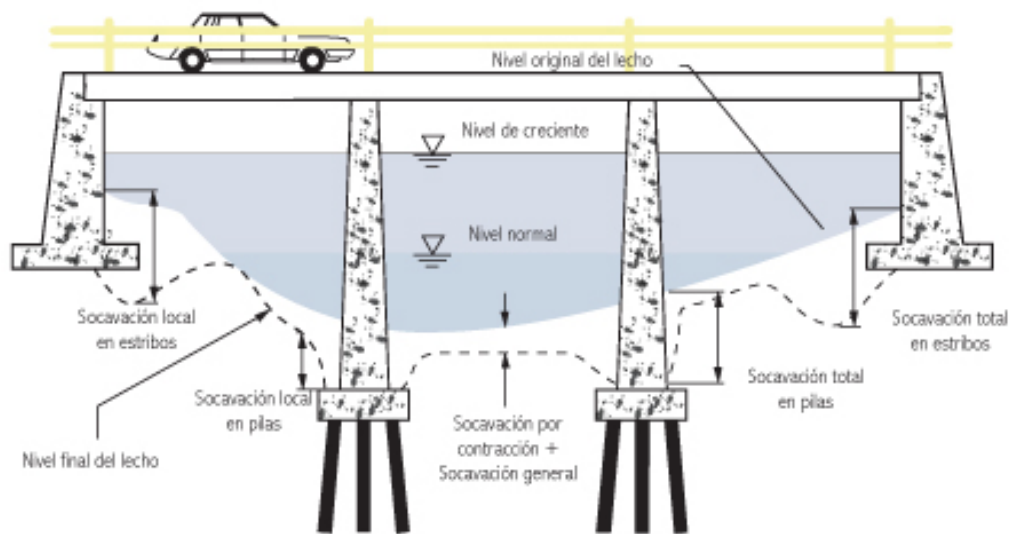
Tipos de socavación que pueden ocurrir en un puente
